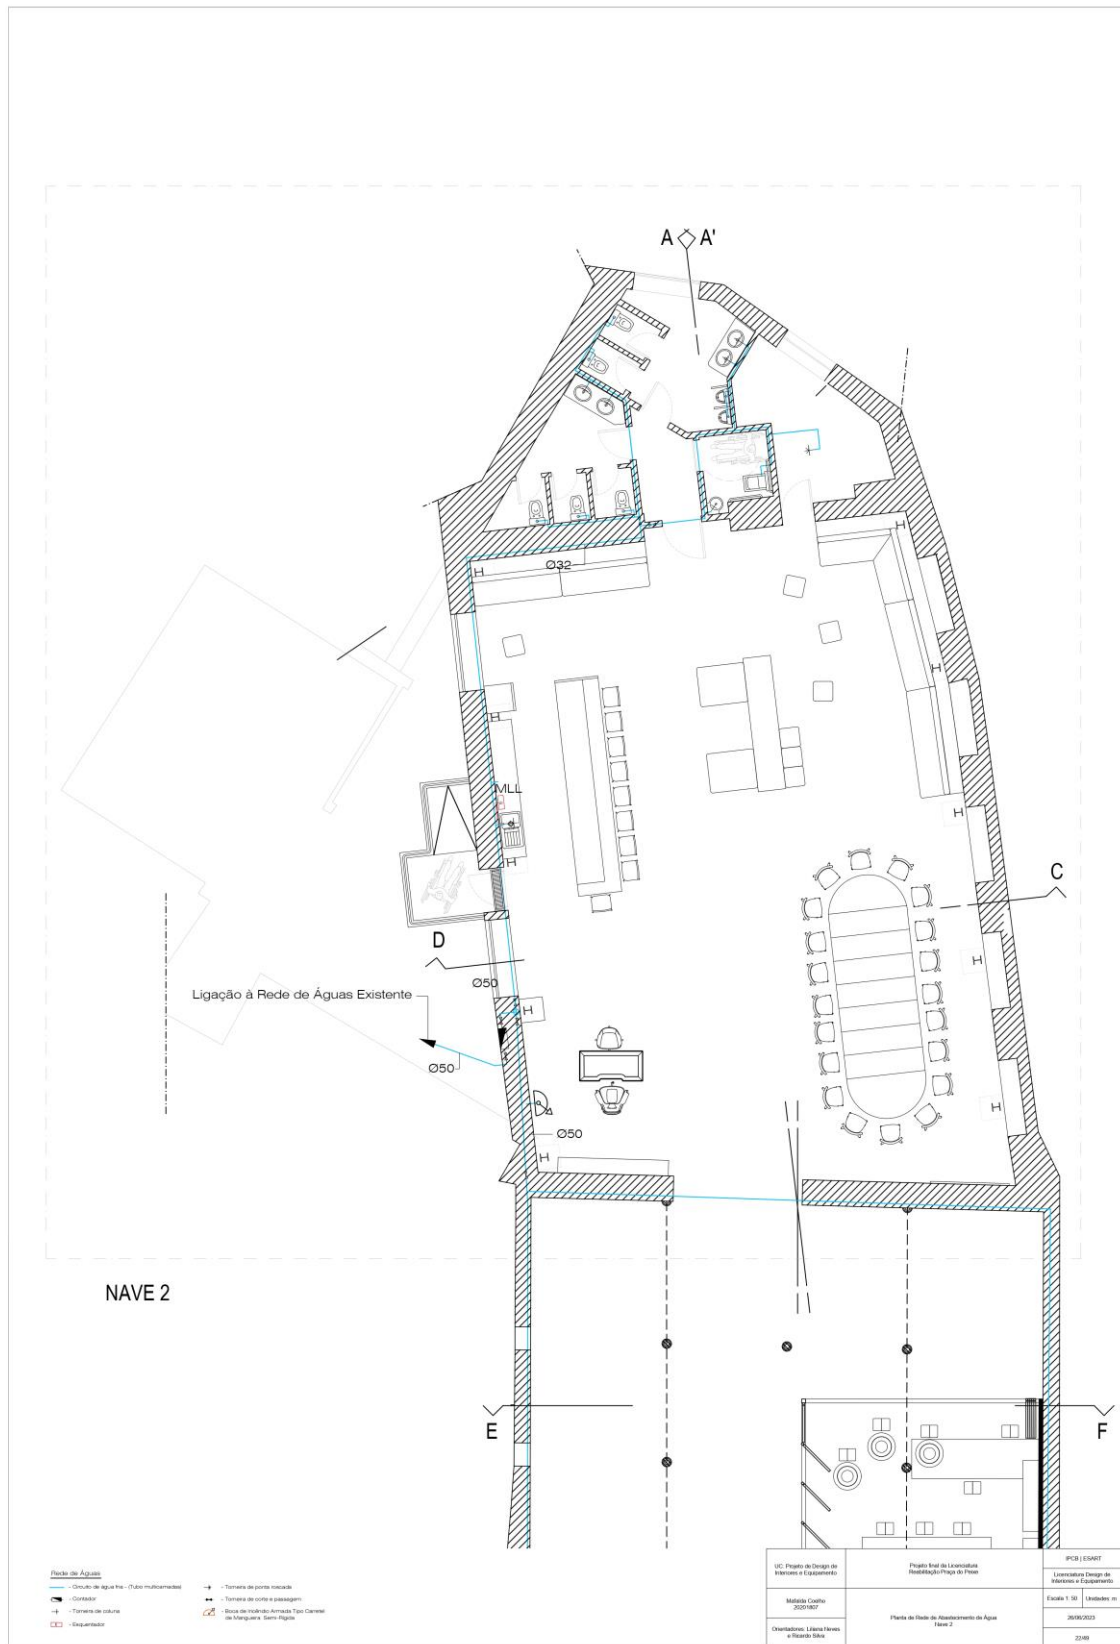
Planta de Rede de Abastecimento de Água Nave 2
